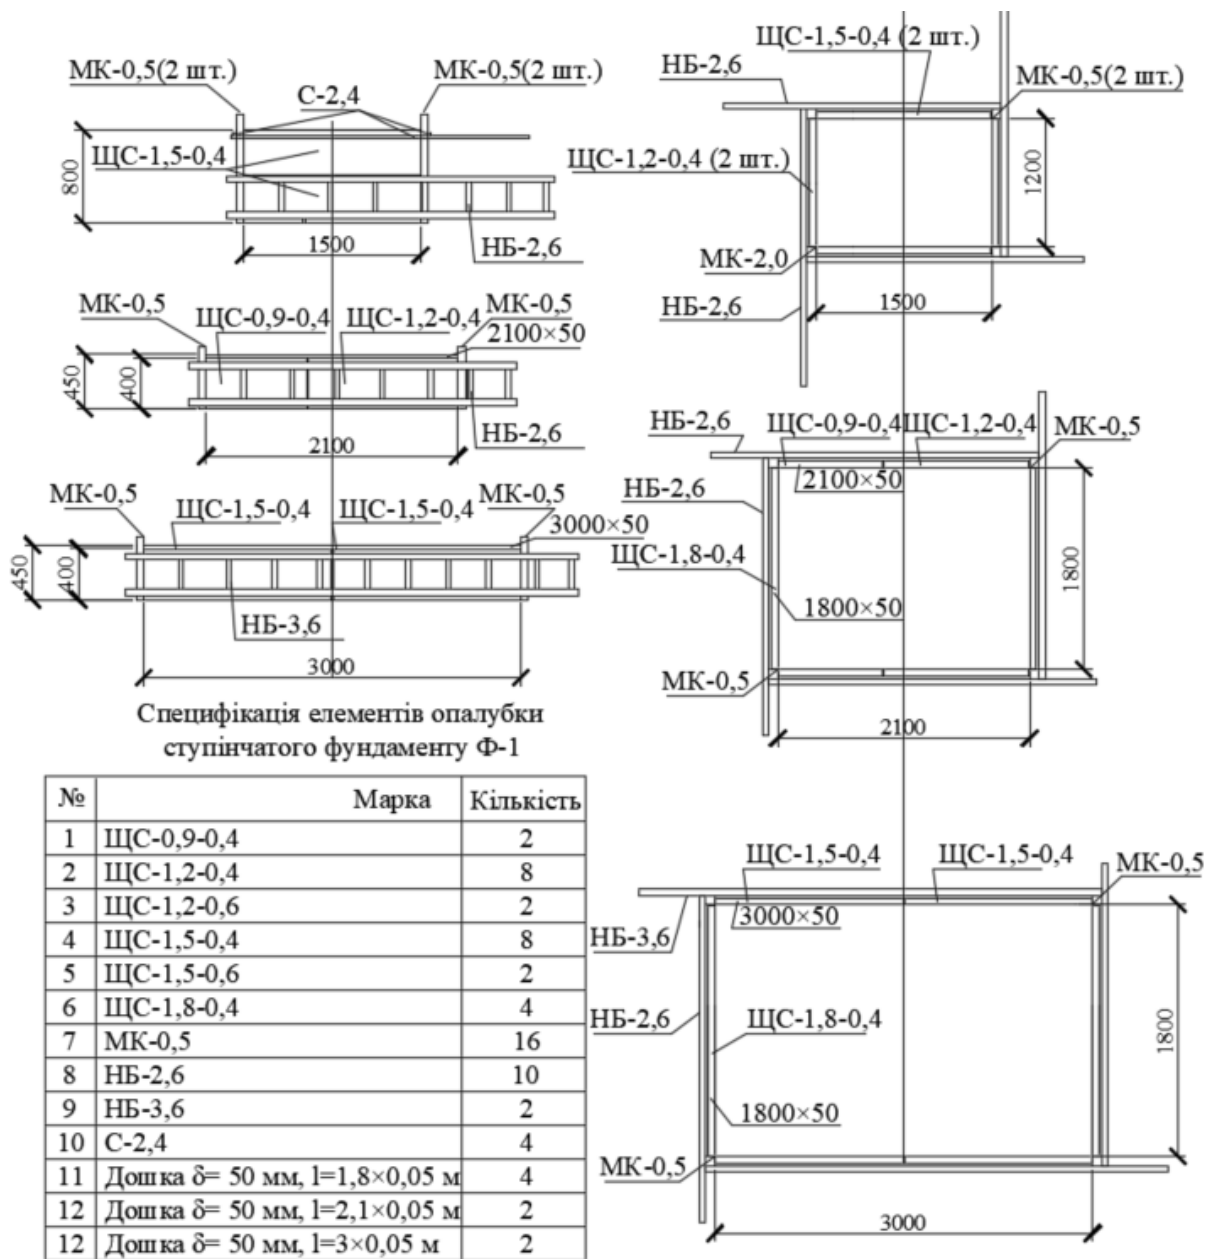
Маркувальна схема ступінчастого фундаменту зі специфікацією елементів опалубки
